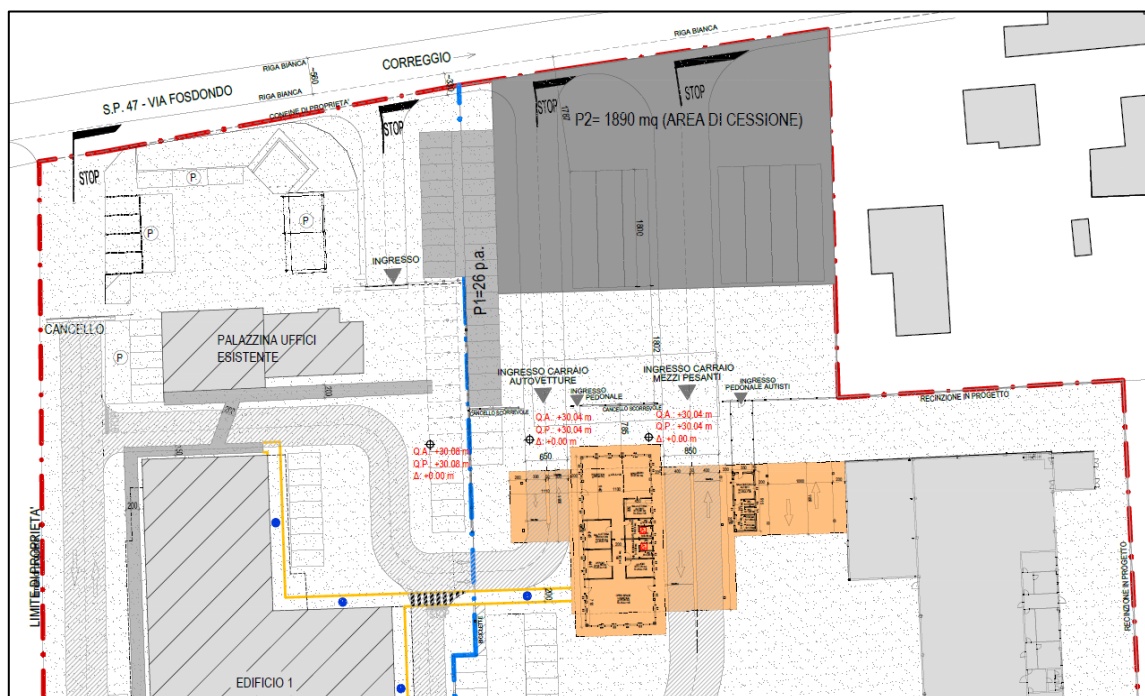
stralcio planimetria di progetto con indicazione del nuovo ingresso
